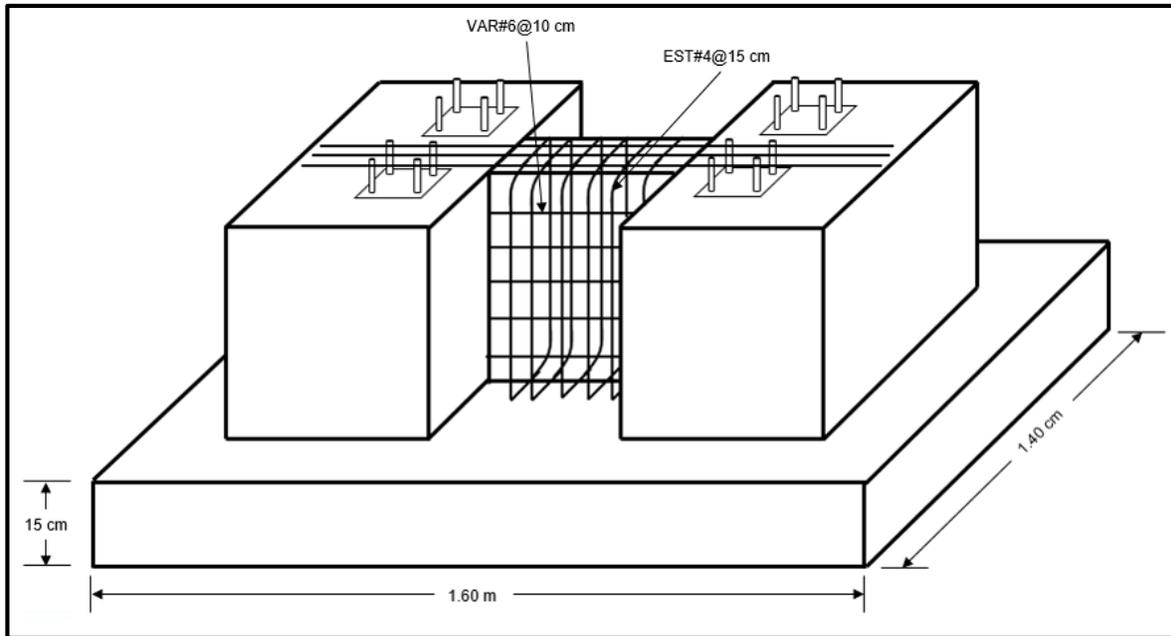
Armado de contratrabe de Zapata Aislada parte de la Cimentación de la Estructura Mayor
